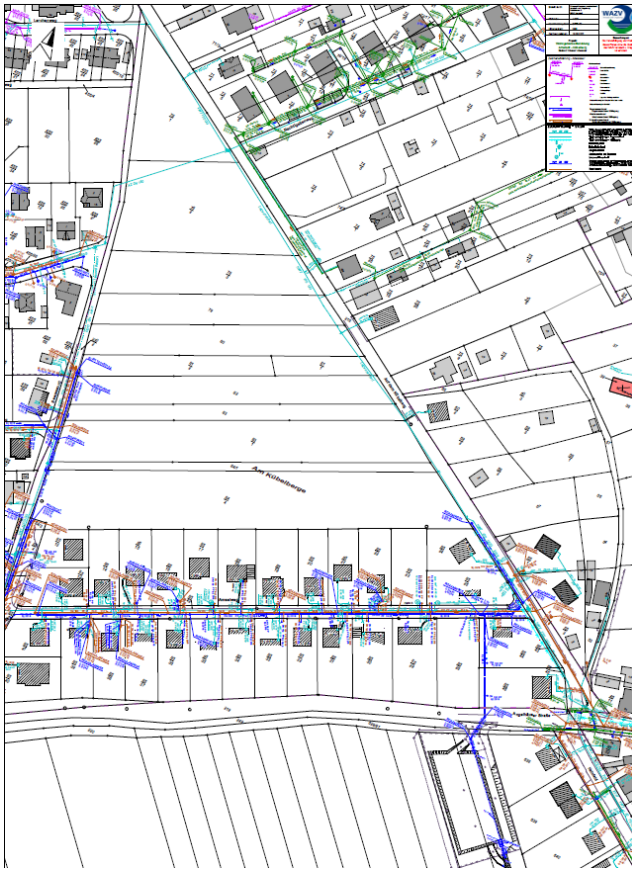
Leitungsbestand Trinkwasser / Abwasser | Quelle WAZV 2021
